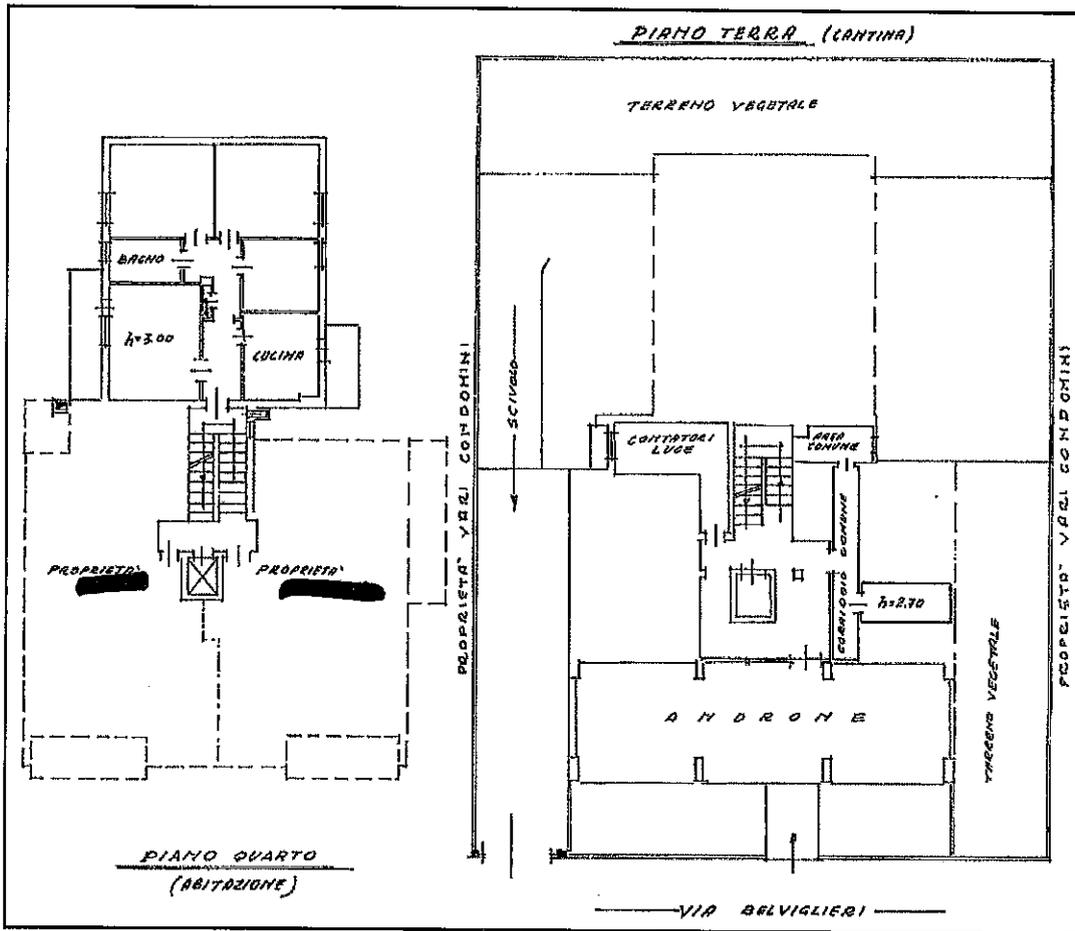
stralcio della planimetria catastale part. 182 sub 11 (abitazione di tipo civile)
